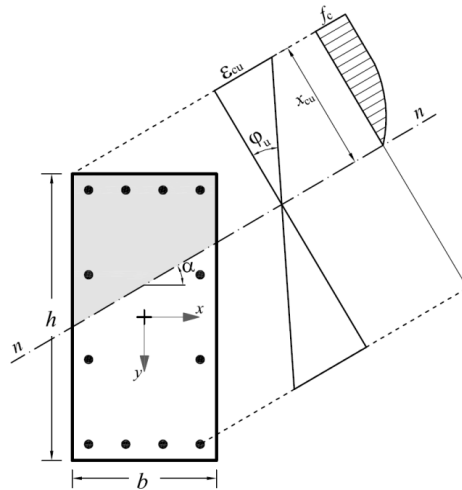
Tensione – Deformazione ultima di una sezione in calcestruzzo armato, soggetta ad azione biassiale
